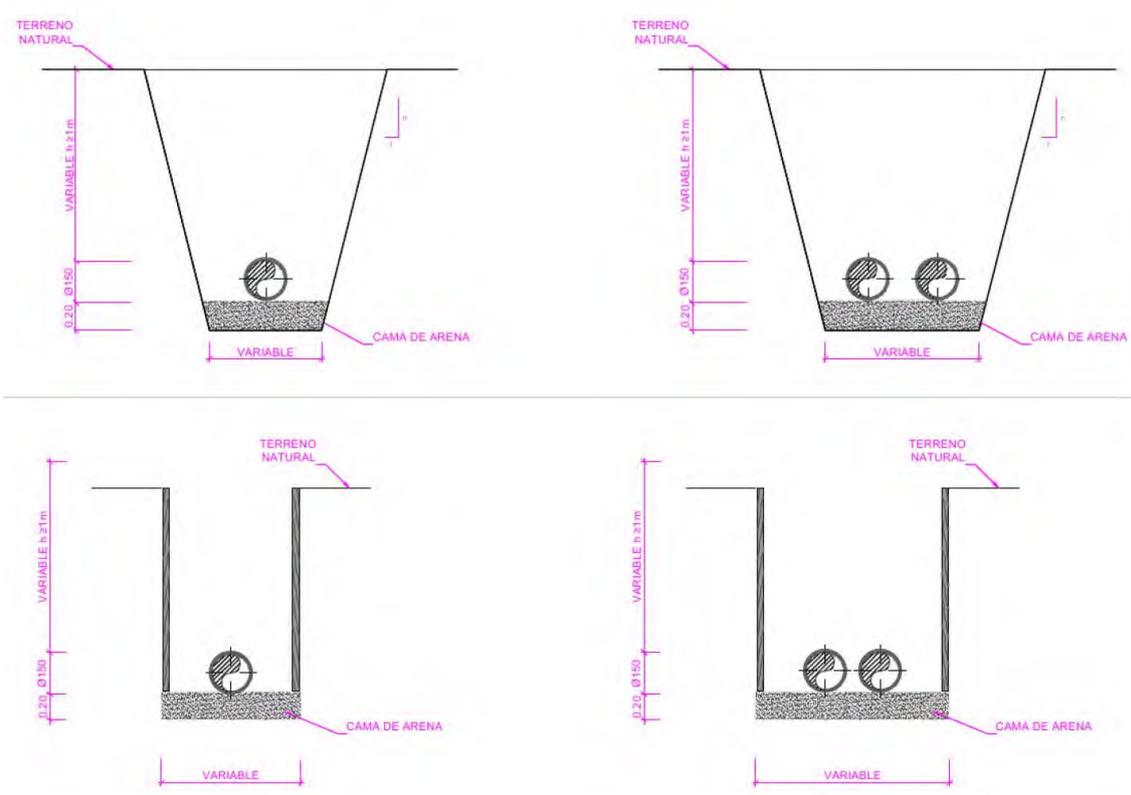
Tipos de zanja a emplear
